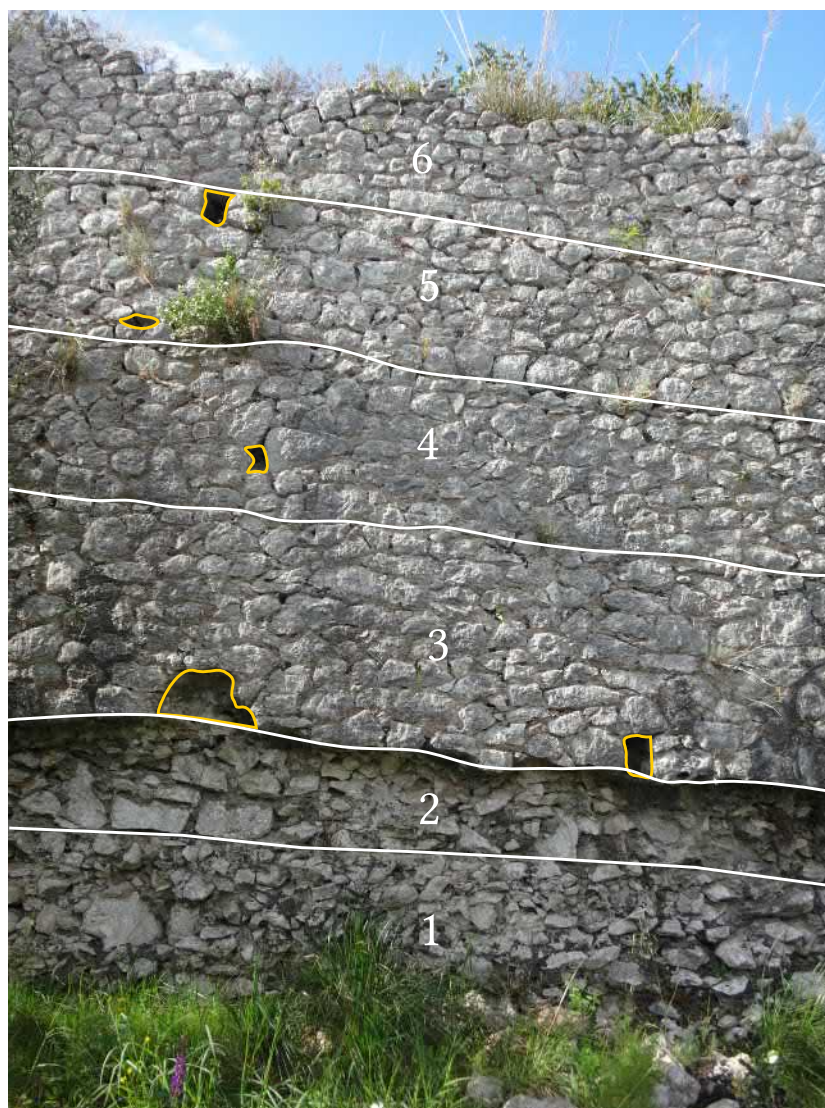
La muraille de Terracine : façade nord entre T5 et T6 (détail)
